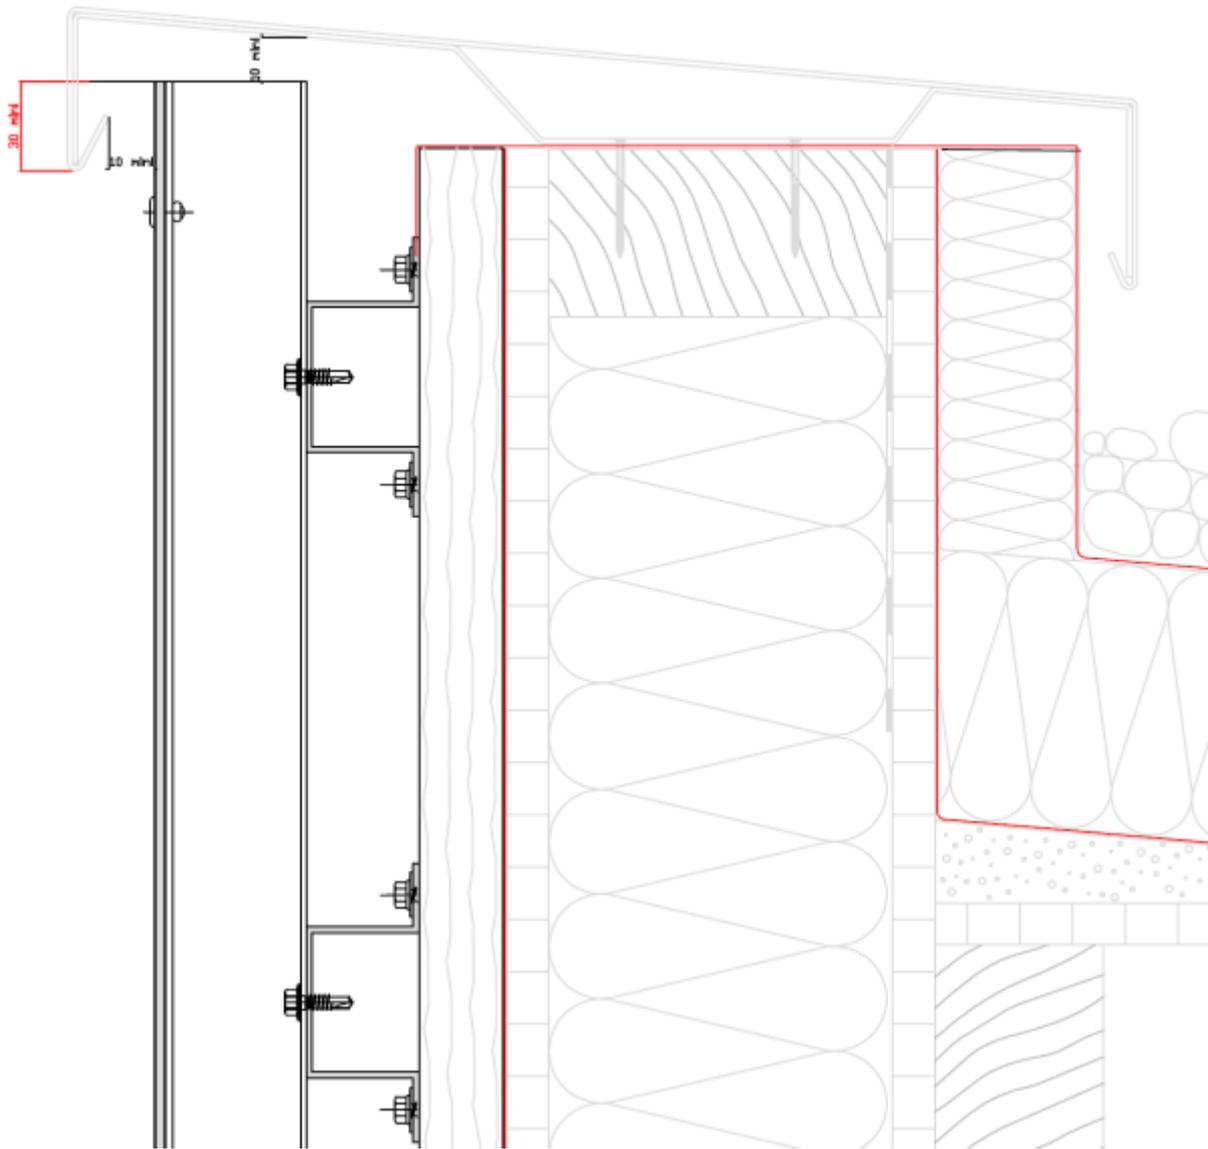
Pose sur COB – Coupe verticale - Triple réseau - Système riveté / vissé - Acrotère
